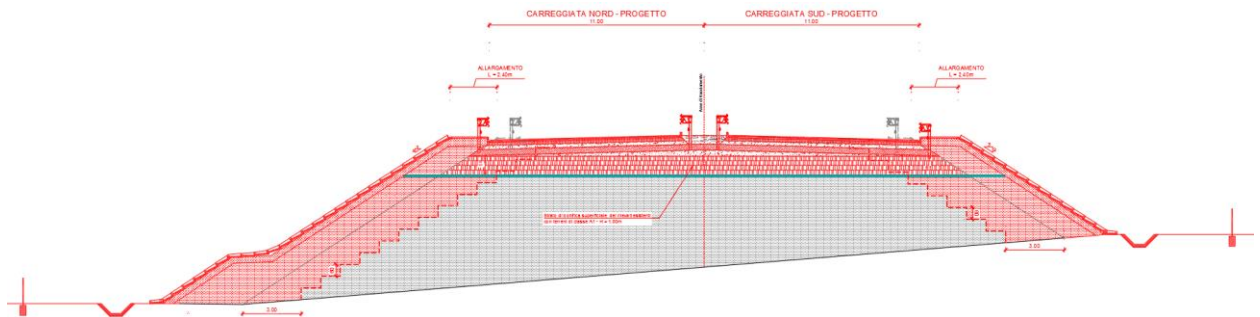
Sezione trasversale dei rilevati con l'indicazione dell'intervento di rifacimento della parte sommitale dei rilevati e della fondazione della piattaforma stradale.
